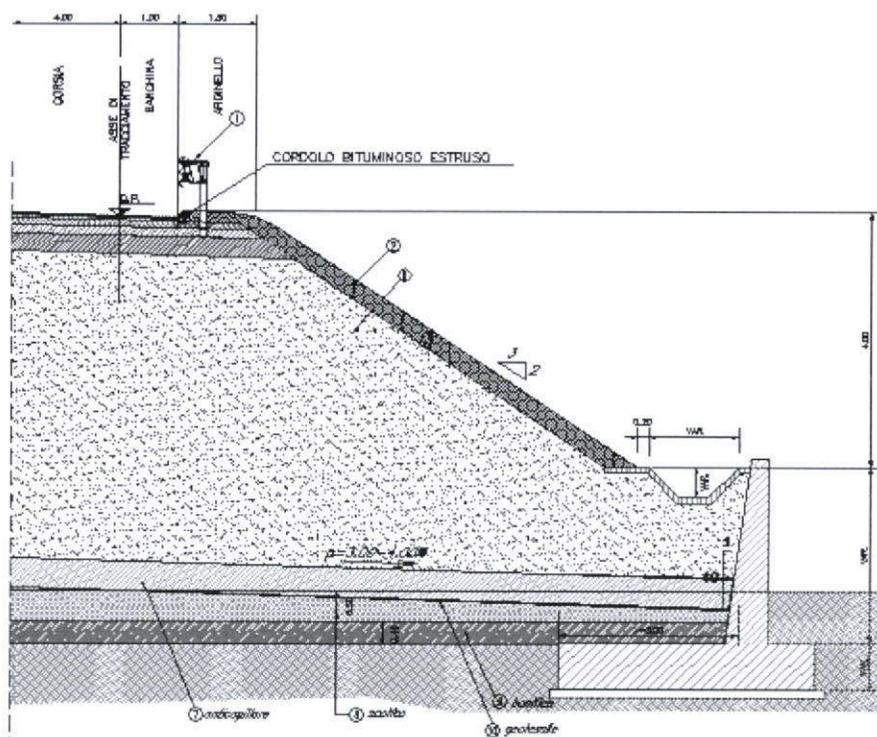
Sezione tipo rampa monodirezionale in rilevato alto con muro di sottoscarpa
